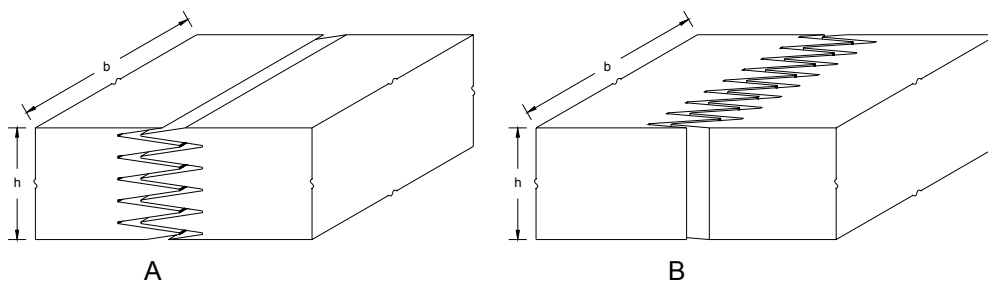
Profil d'un joint horizontal (A) et vertical (B)
